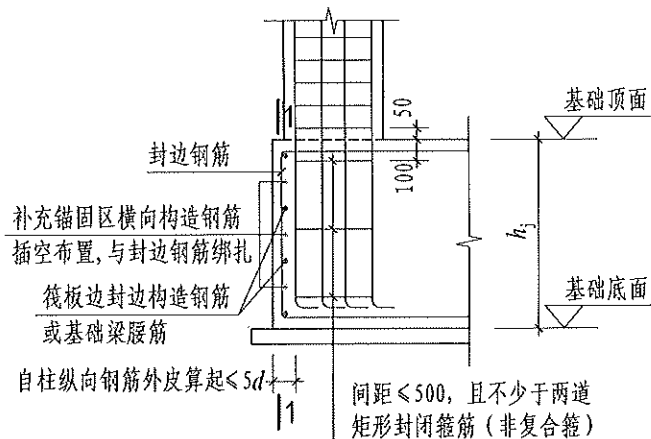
柱纵向钢筋外侧设有构造钢筋
